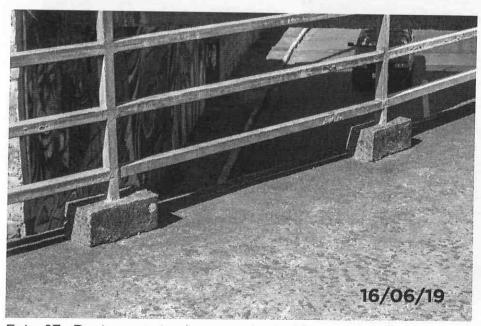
Destacamento do concreto do bloco e fixação da guarda corpo.
